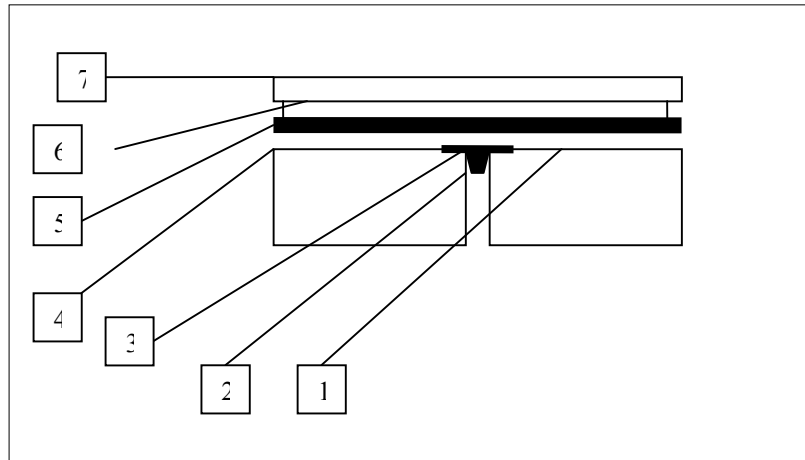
Sistema de recuperação de fissuras em fachadas.
